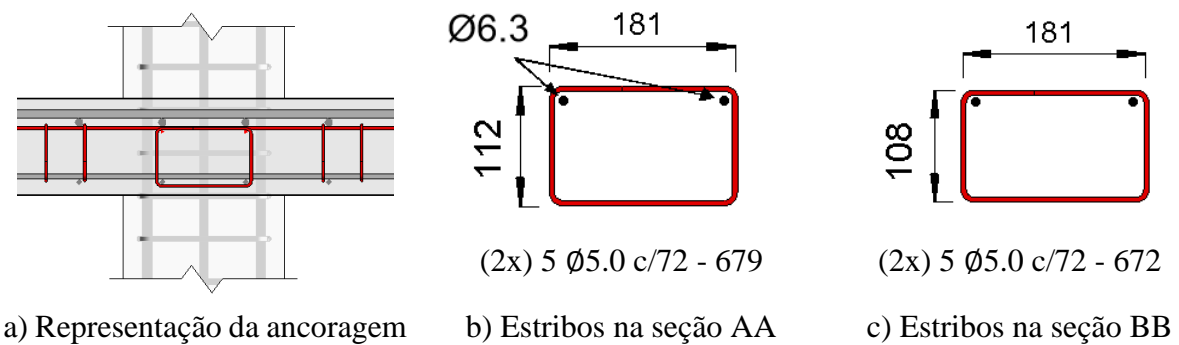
Detalhamento dos estribos da laje CA-05 (unidades em mm)
